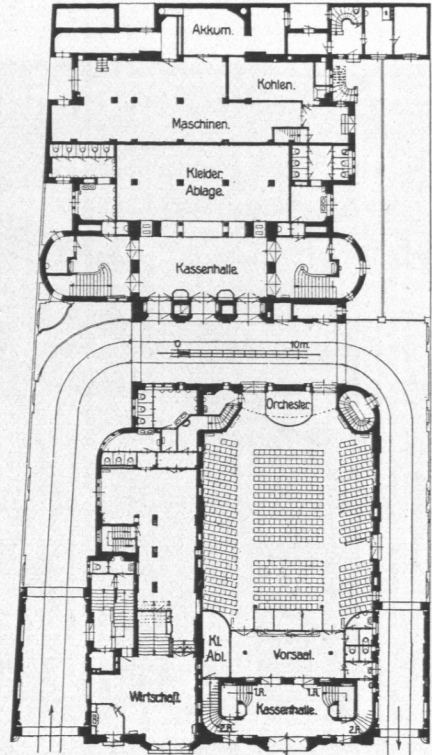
Bürgerfäle Eilbeck, Erdgeschoss, Grundriß.
